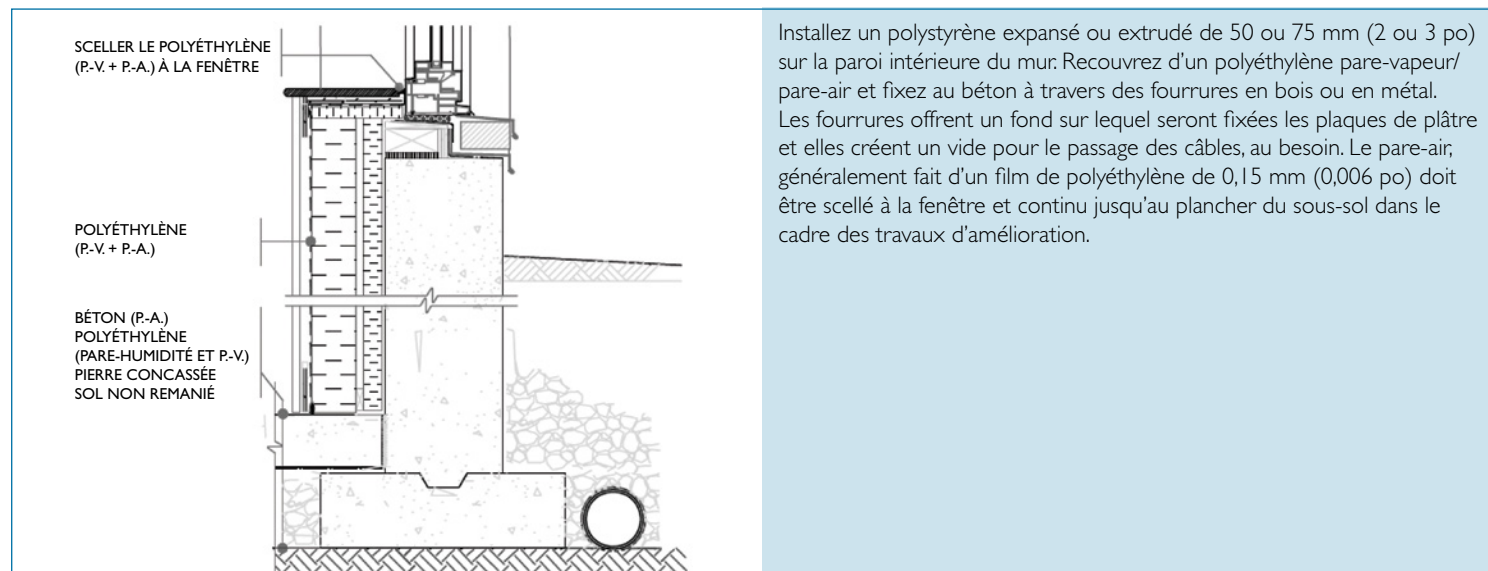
Murs sous le niveau du sol – isolation additionnelle du côté intérieur du mur de fondation
